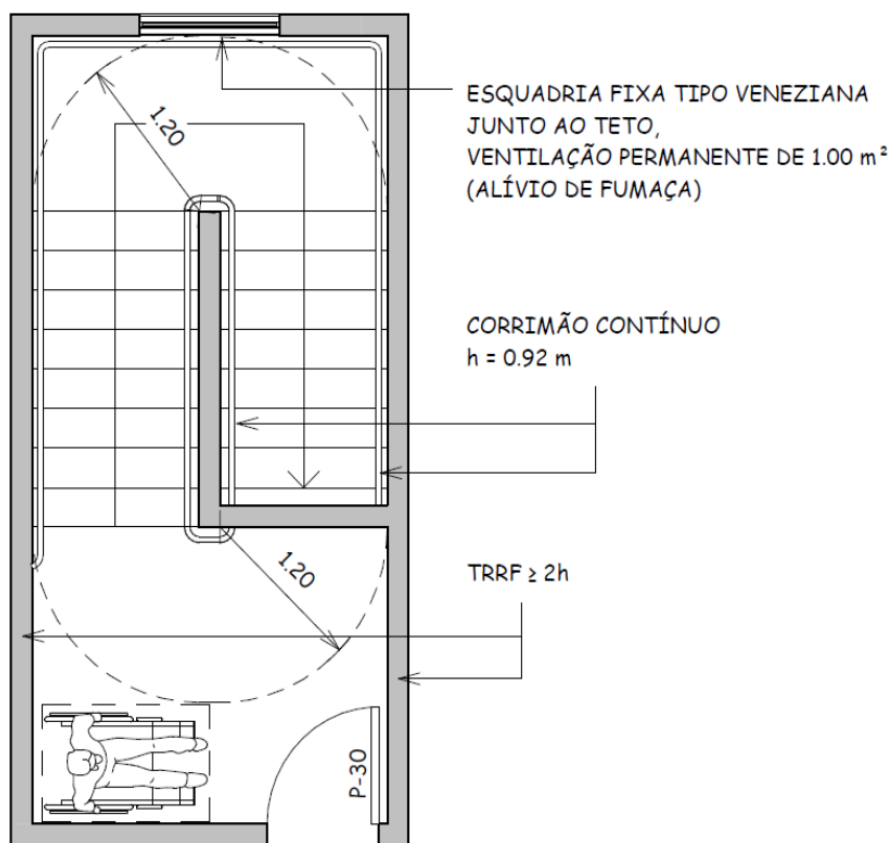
C - Escada protegida - último pavimento (planta baixa).
